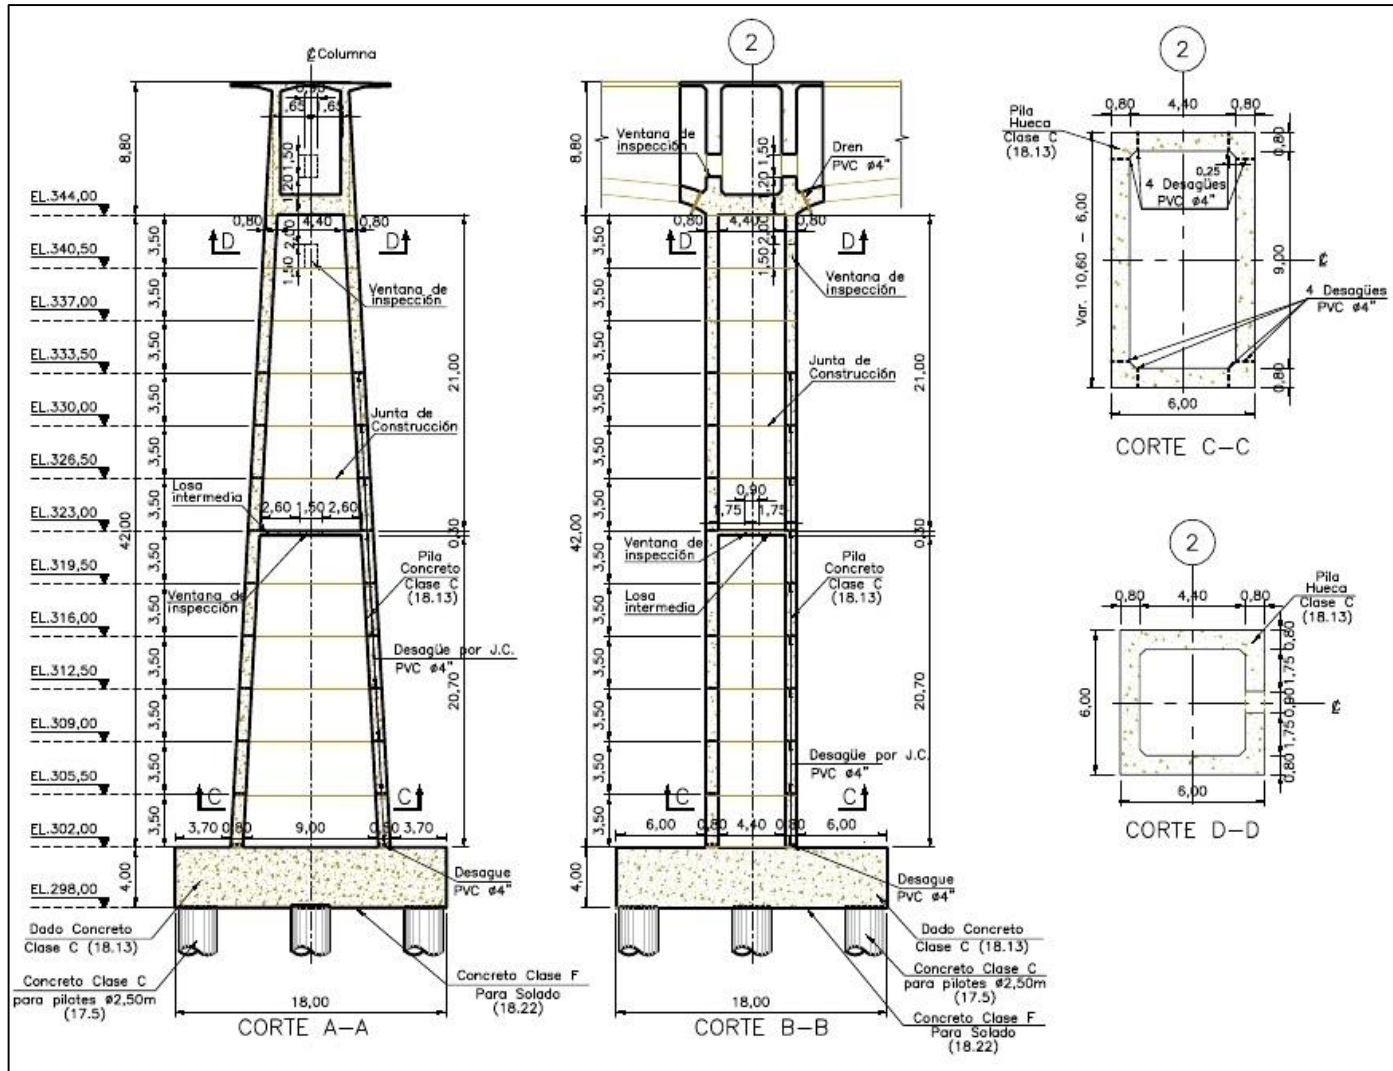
Perfil de la Pila 1 - Eje 2 en dirección longitudinal y transversal.
